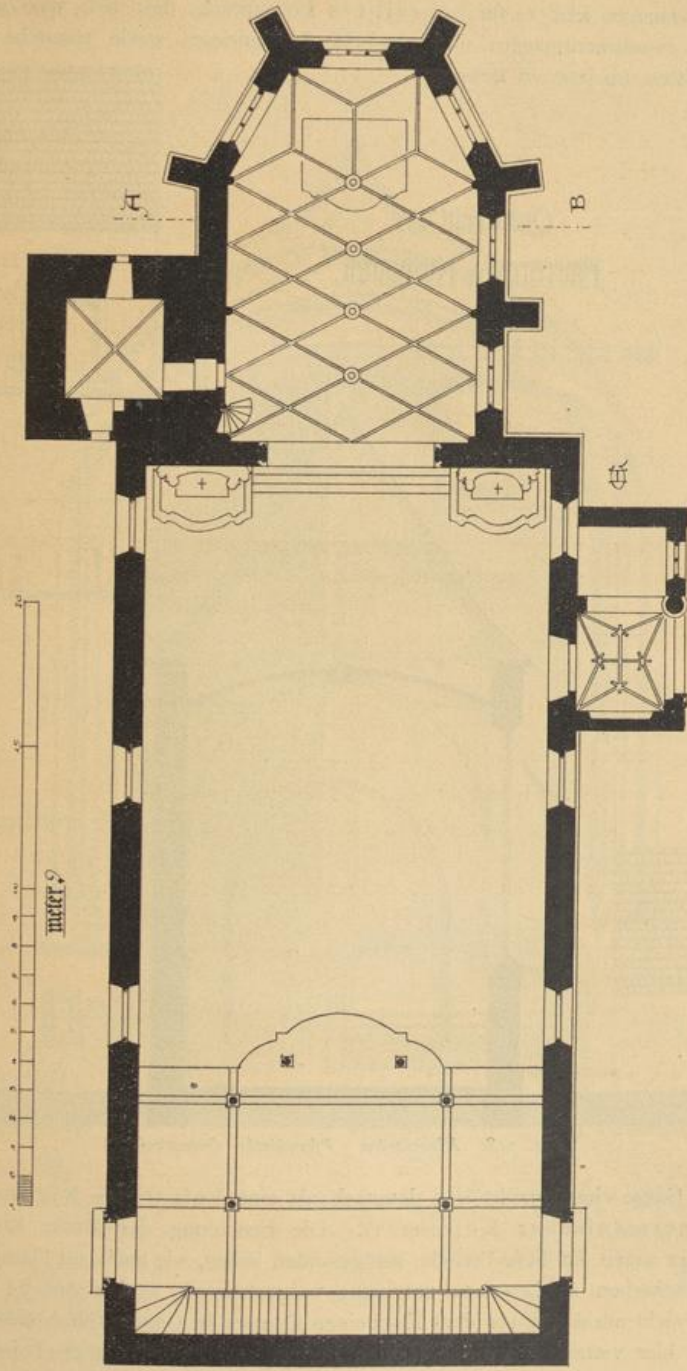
Kirchzarten. Pfarrkirche, Grundriß.
